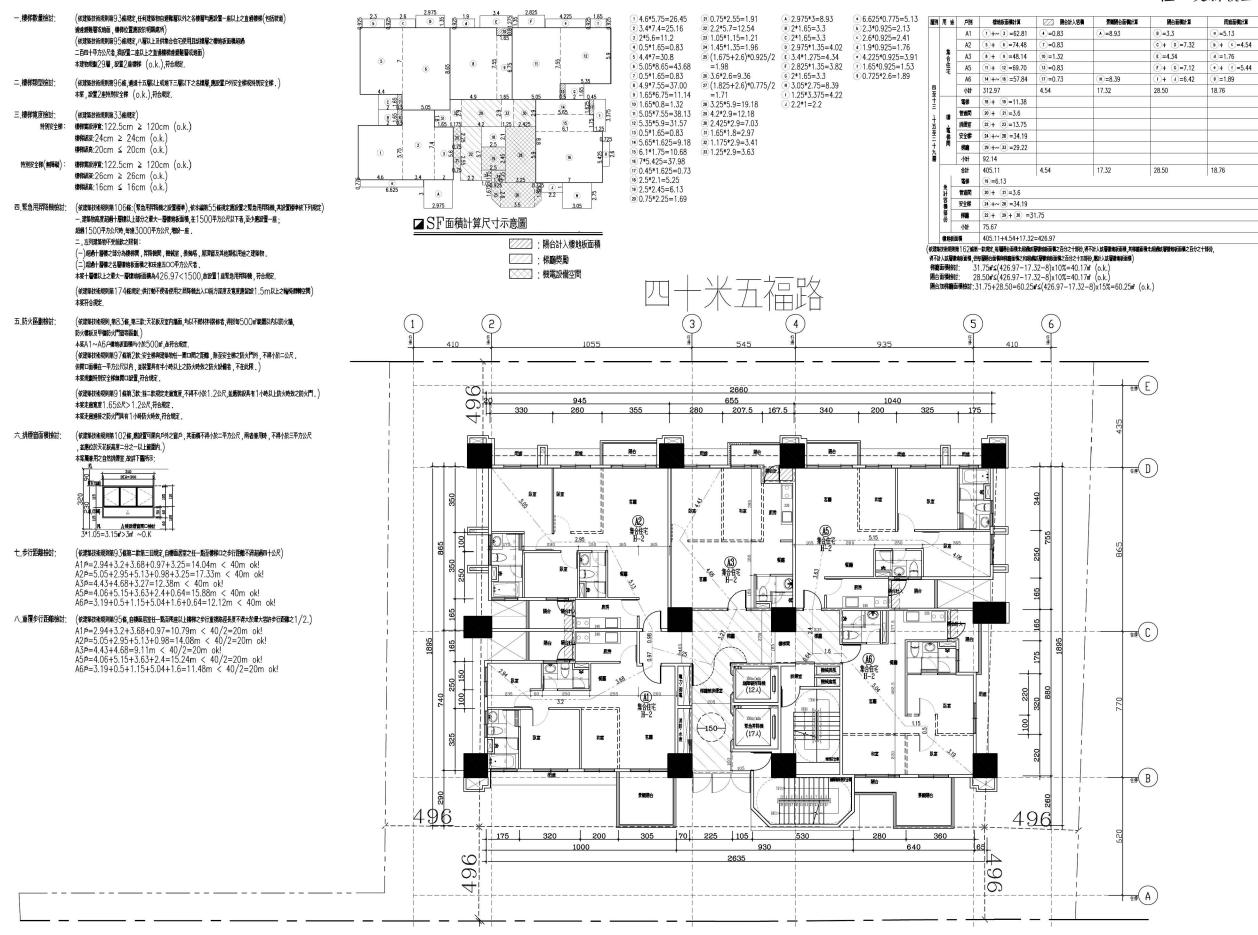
地上 4 至 13 層、15 至 29 層平面圖 (比例尺 1/200)
